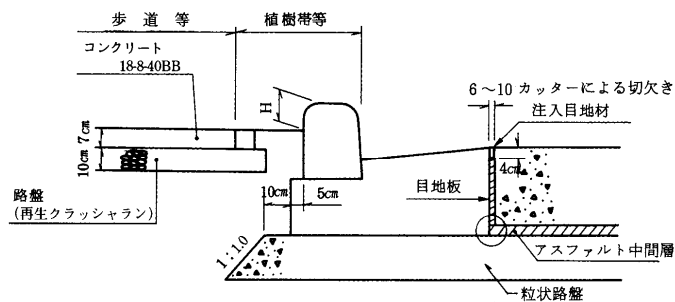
Ⅲ-41 コンクリート舗装（歩道部）
